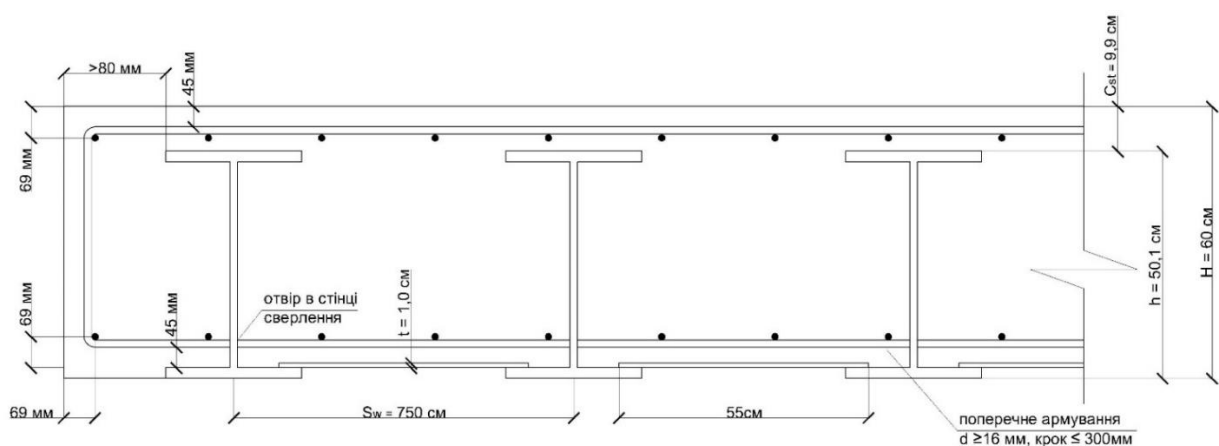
Фрагмент плити прогонової будови у поперек мосту
